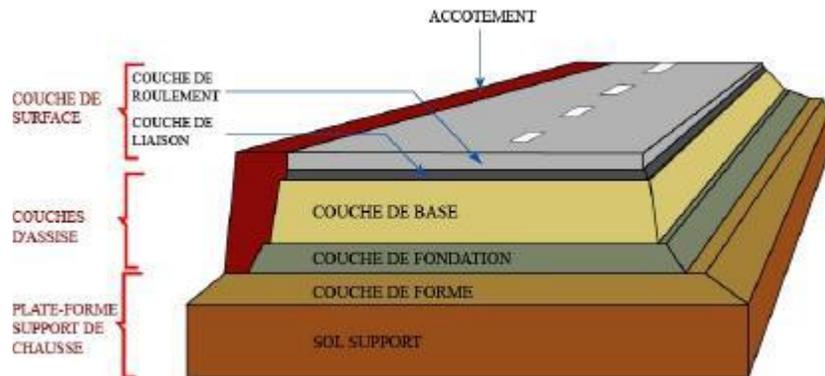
Coupe type d'une structure de chaussée et terminologie des différentes couches.
